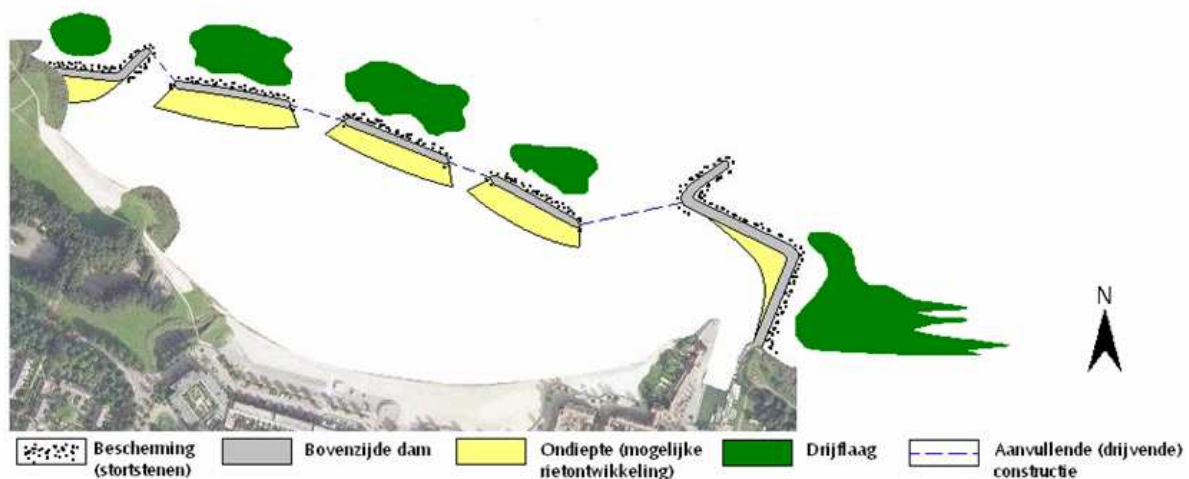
Variant 2 voor de bestrijding van algenoverlast in Almere-Haven.
